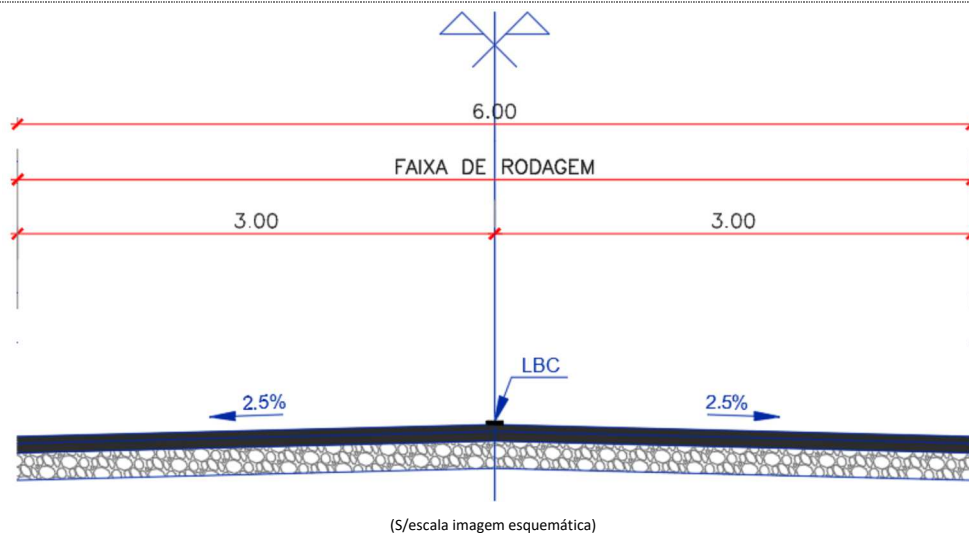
Perfil Transversal Tipo – Traçado EM1139
